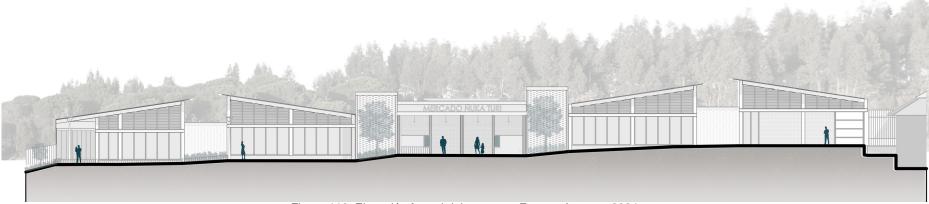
Elevación frontal del proyecto. Fuente: Autores, 2024
